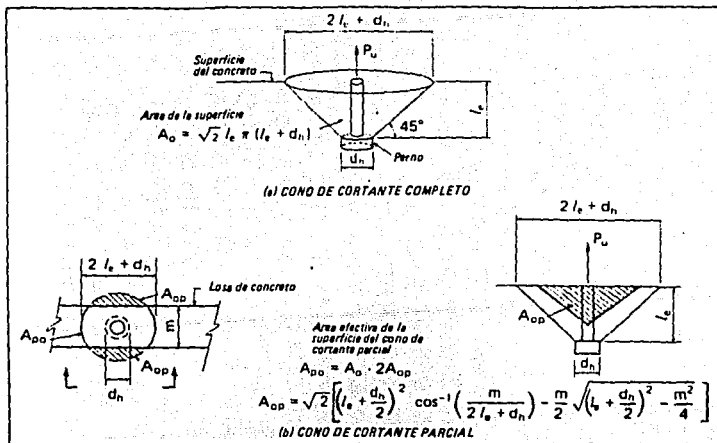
CONECTORES DE PERNO CON CABEZA SOLDADA.
